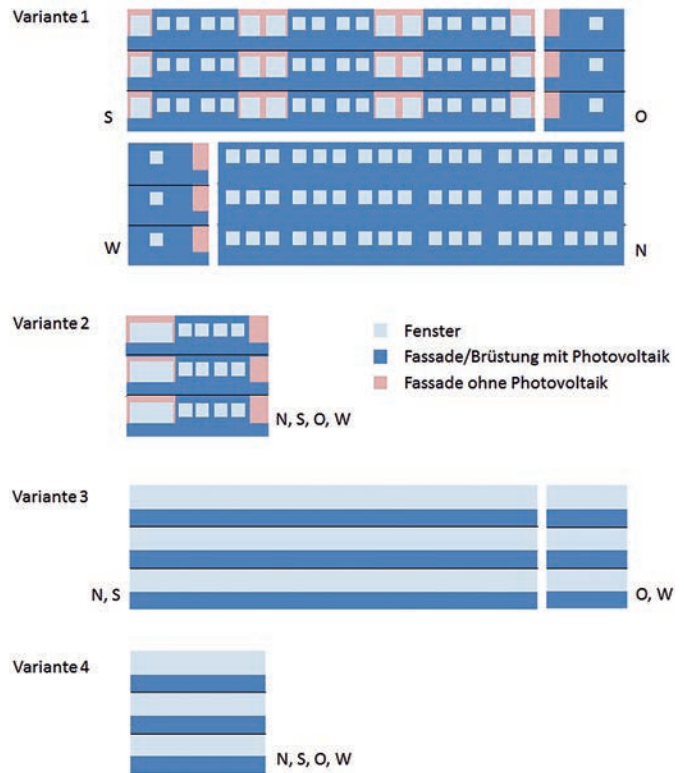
Schematische Darstellung der Fassadenansichten der vier betrachteten Varianten
